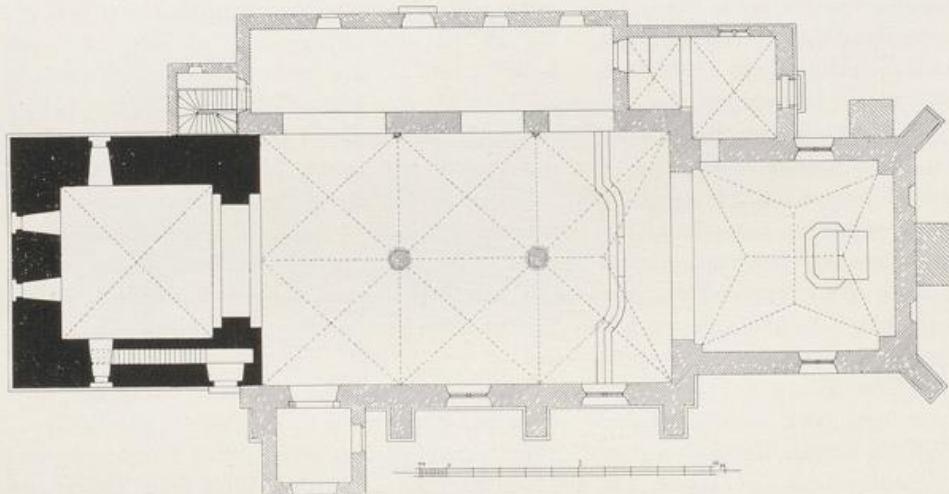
Hochkirchen. Grundriss der kathol. Pfarrkirche.
